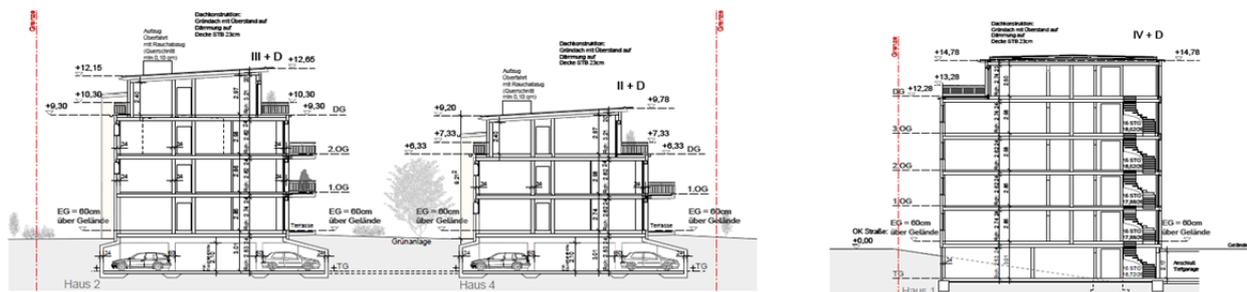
Schnittzeichnungen der geplanten Bebauung Windthorststraße, Dipl. Ing Guido Zickgraf, ohne Maßstab
